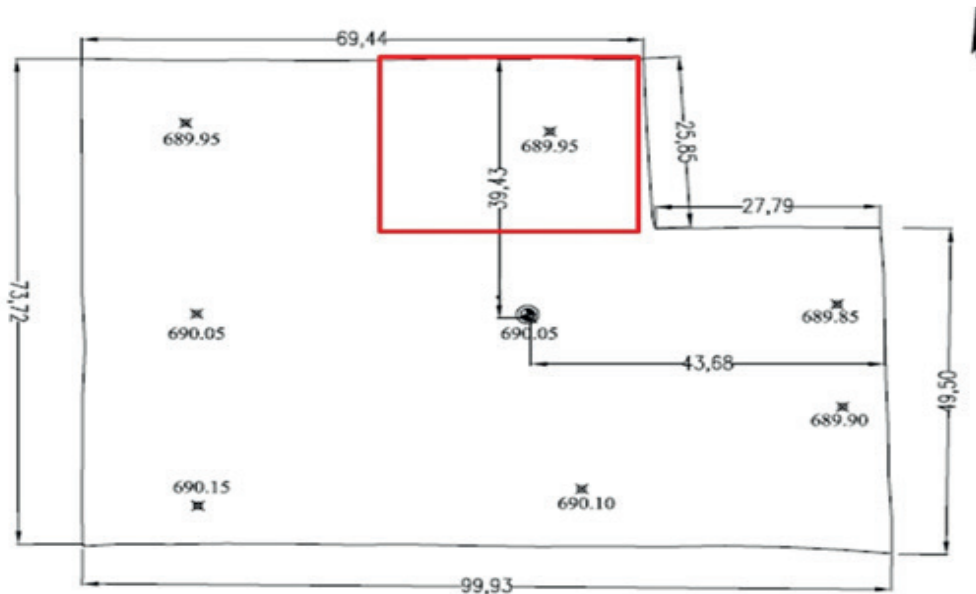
En rojo se indica zona a utilizar para la construcción de la playa de secado dentro de la locación. (Ejemplo, figura ilustrativa no excluyente)
